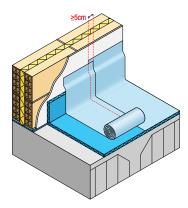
Colocación de la barrera impermeable sobre una capa anti-impacto de EEPS.
